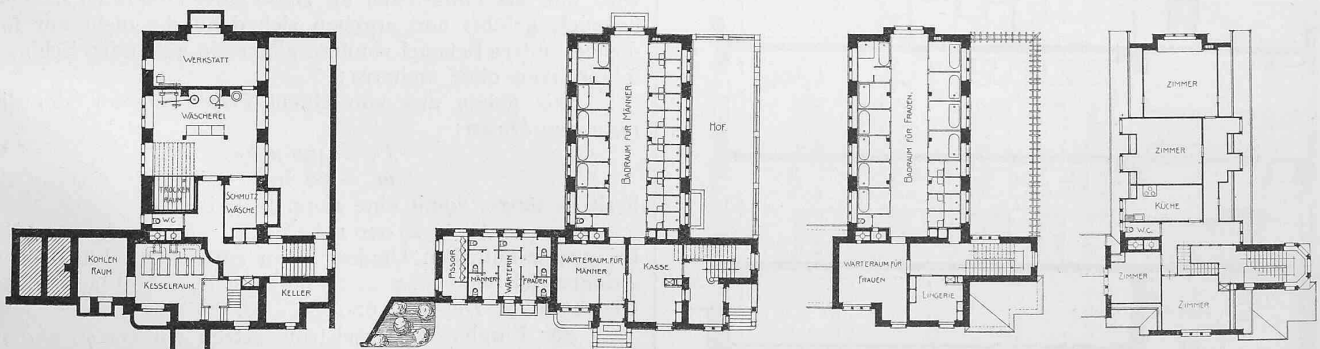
bis 6. Grundrisse vom Keller, Erdgeschoss, ersten Stock und Dachgeschoss. — Masstab 1 : 500.
